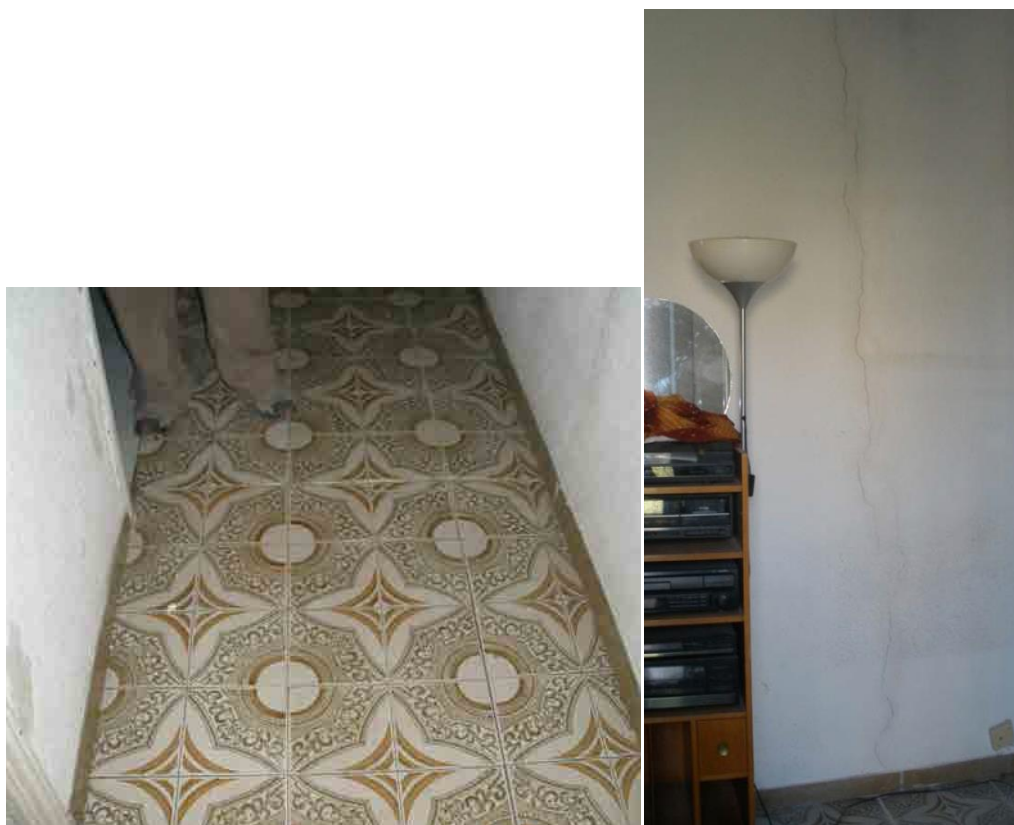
Esquerda vertical en mur que continua per paviment (Grup d'esquerdes A, planta entresòl)
